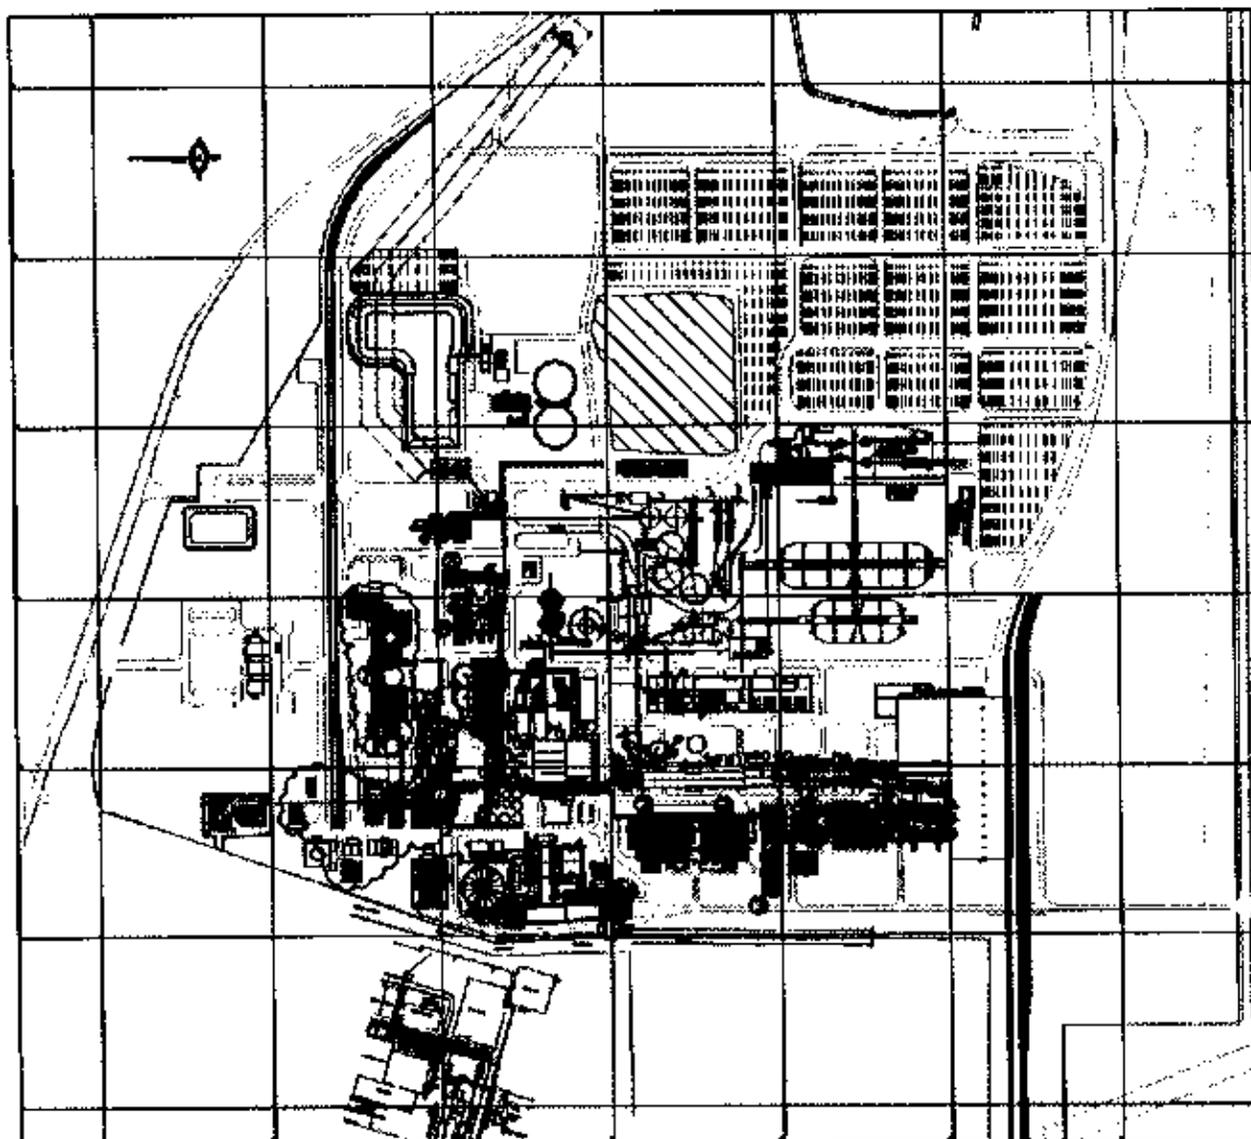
Áreas de Intervención dentro de Planta Santa Fe.
